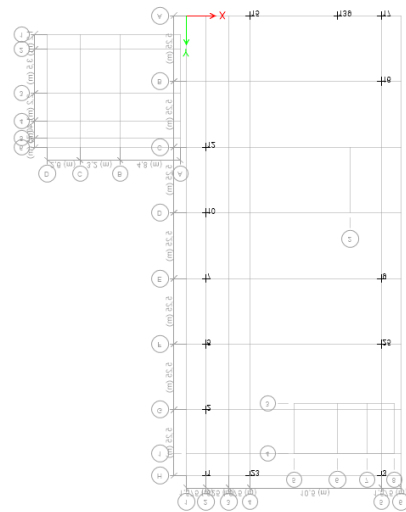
Layout Struktur pada Elev. +13,6 Gedung A
